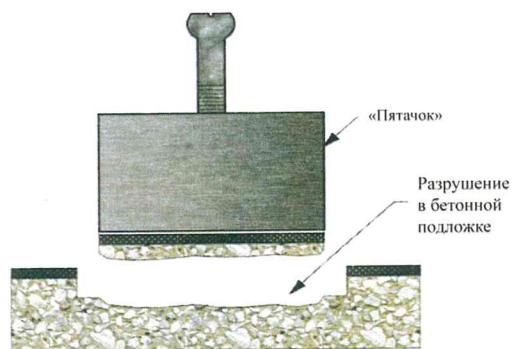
Схема когезионного разрушения бетонной подложки
